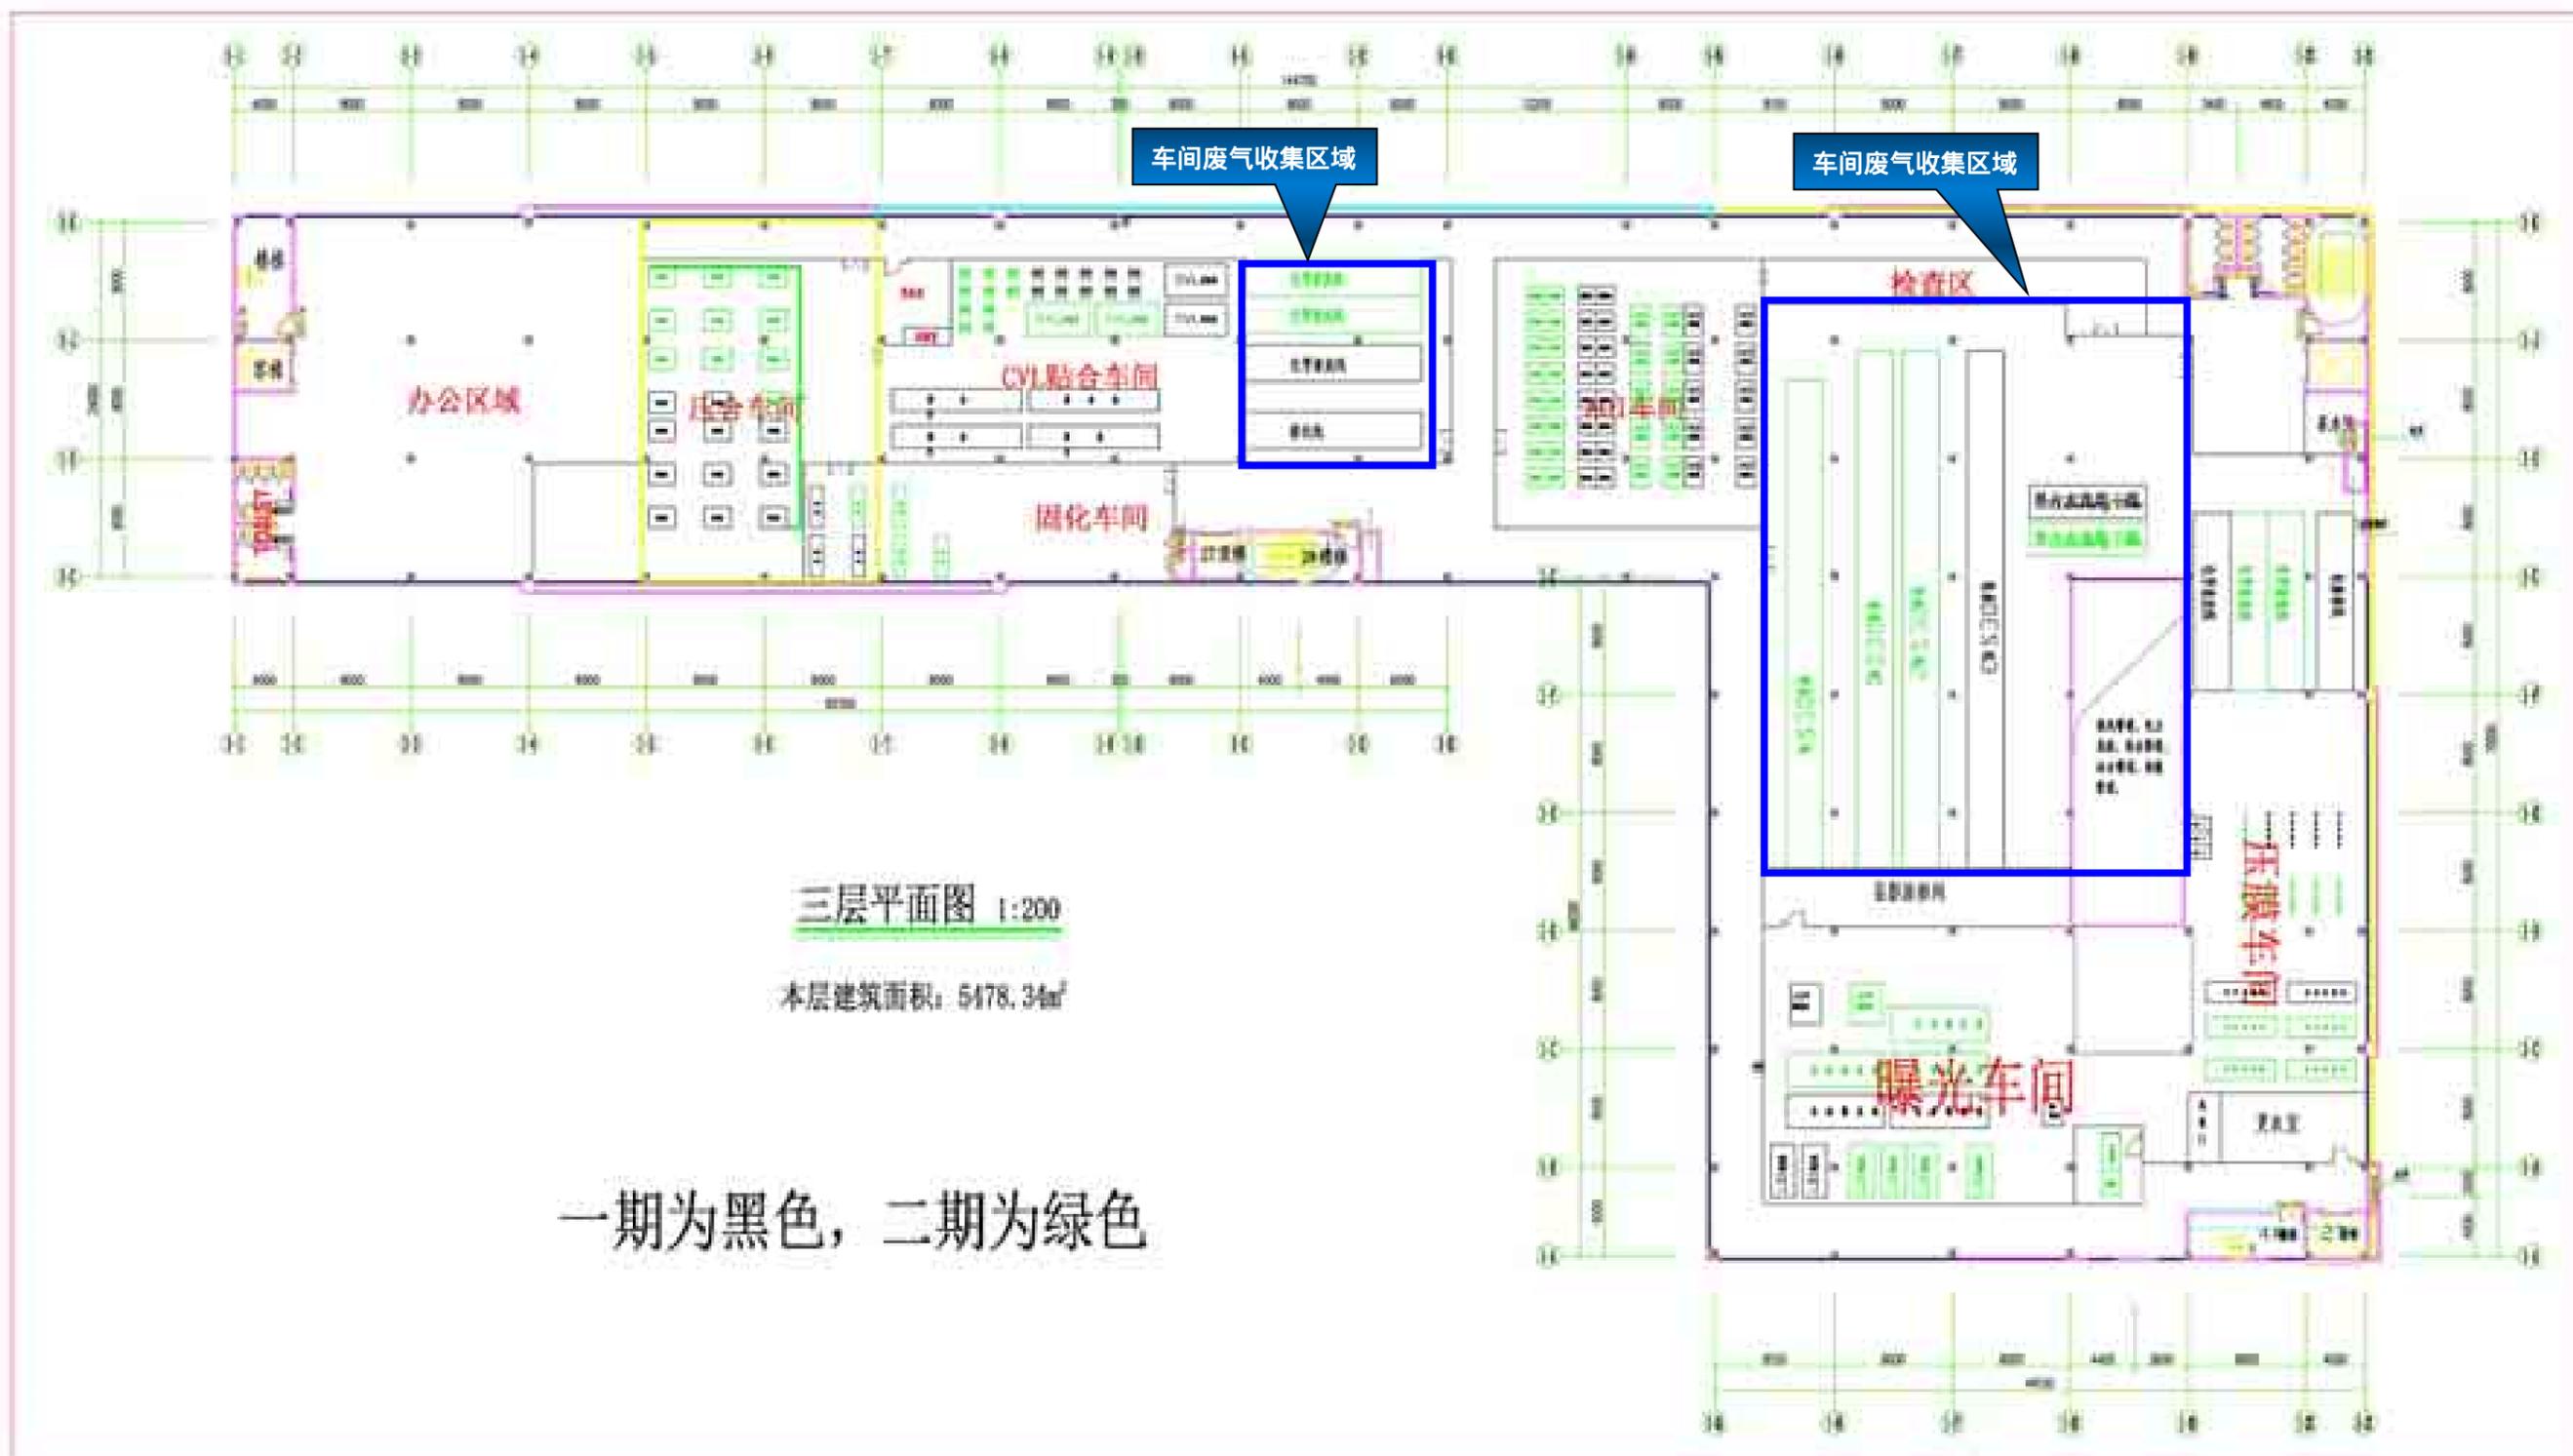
(c) 本项目 1# 厂房平面布置图 (三层)
